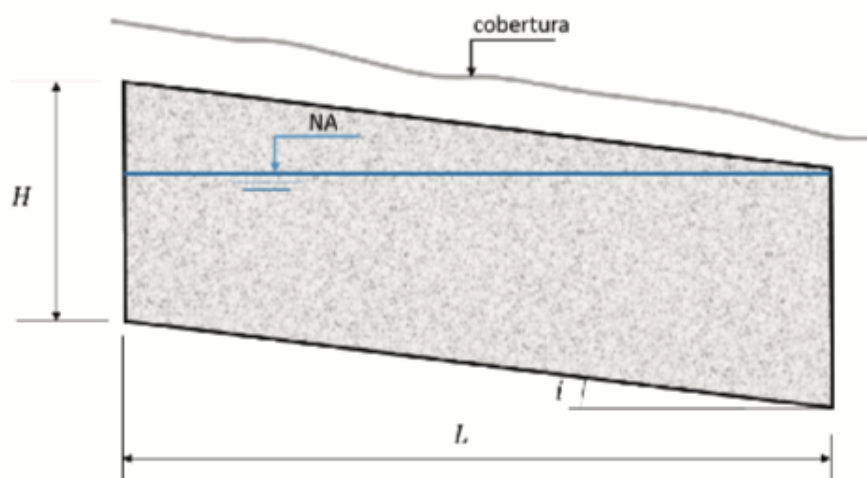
Esquema de configuração de trincheiras de infiltração, corte longitudinal (ADASA, 2018).
